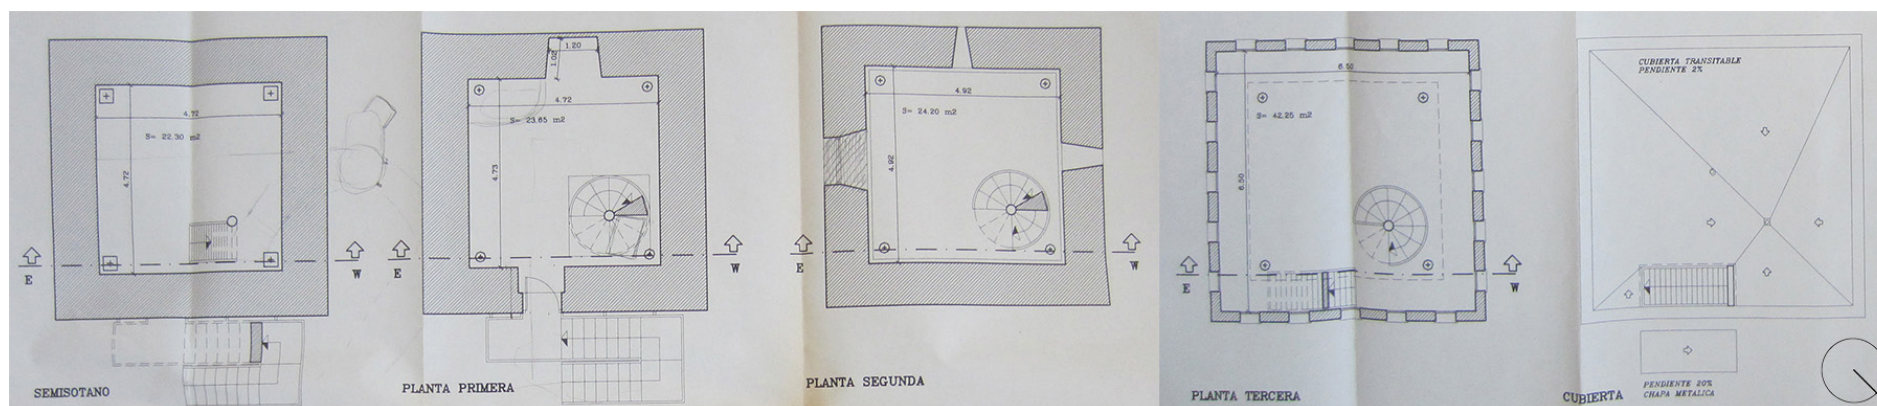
Plantas del anteproyecto de restauración de la Torre de Canals. Se muestra que la escalera de caracol esta planteada en una esquina de la planta, mientras que en la actualidad se ubica en el centro. (Según Encarna Bosch)
